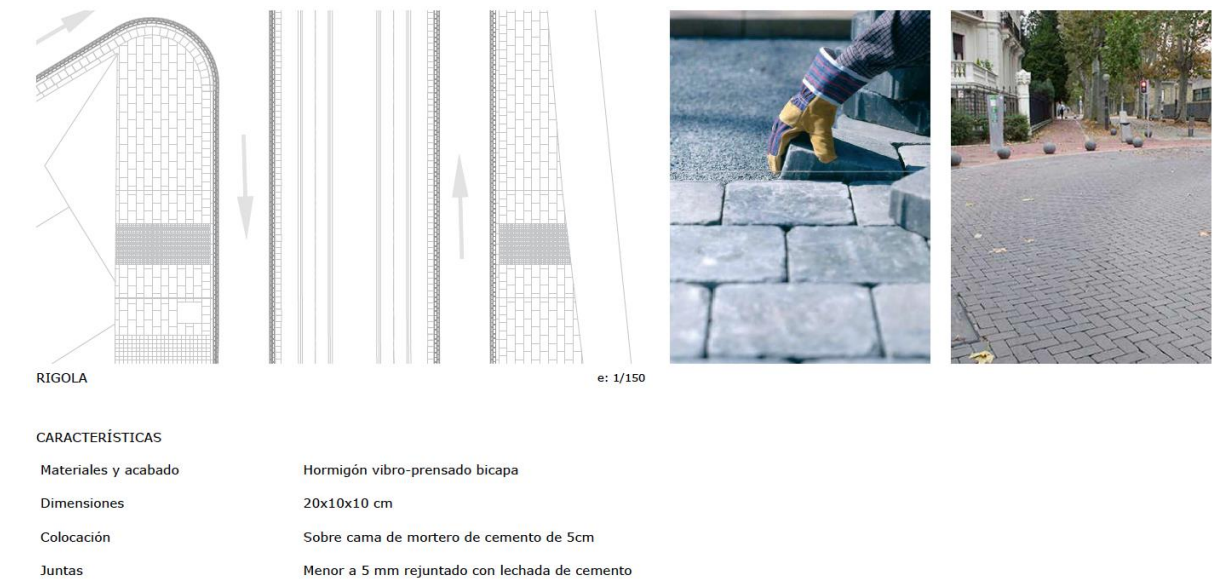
Despiece y material para la rigola constante para cada una de las alternativas
